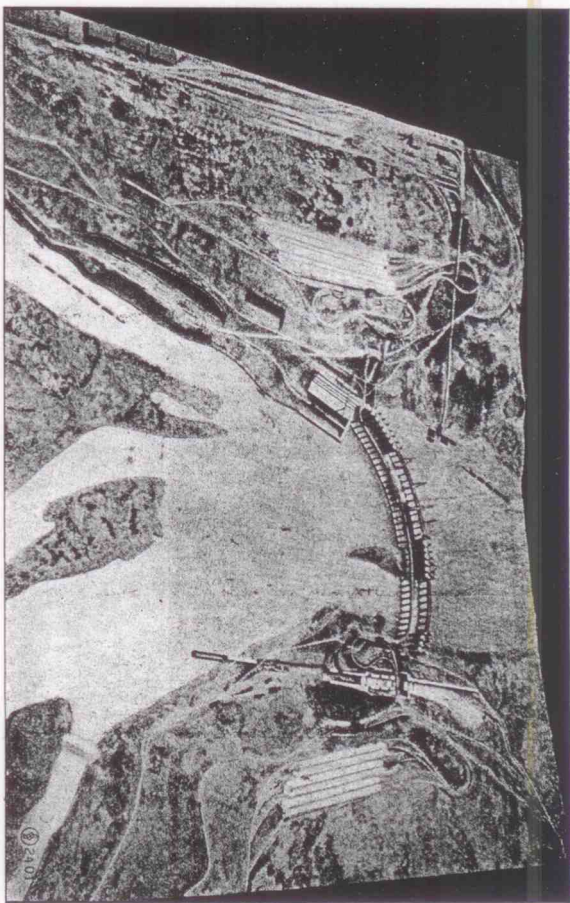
Photo da maquete, não só da barragem que pouco adiantaria, mas de todas as installações tanto as da construção como as definitivas — todo o plano de execução e utilização. (3).
